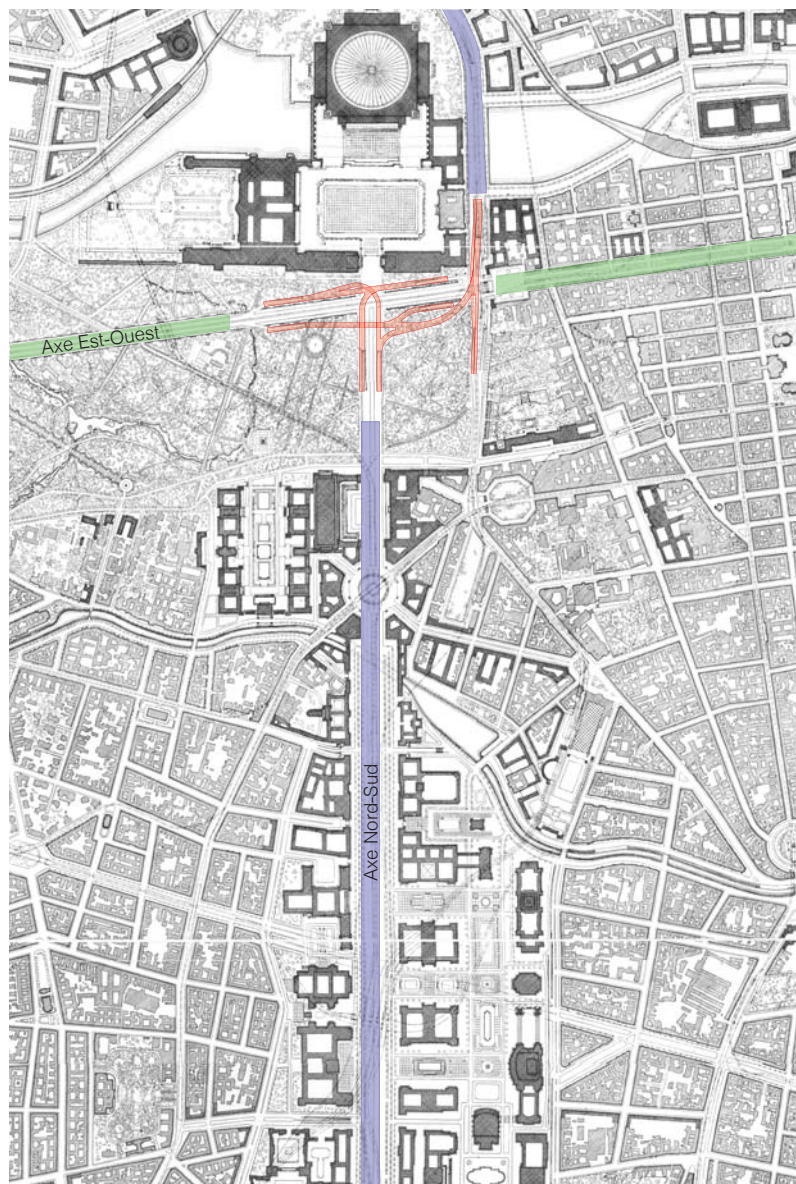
Plan de situation des tunnels dans le contexte de Germania.
